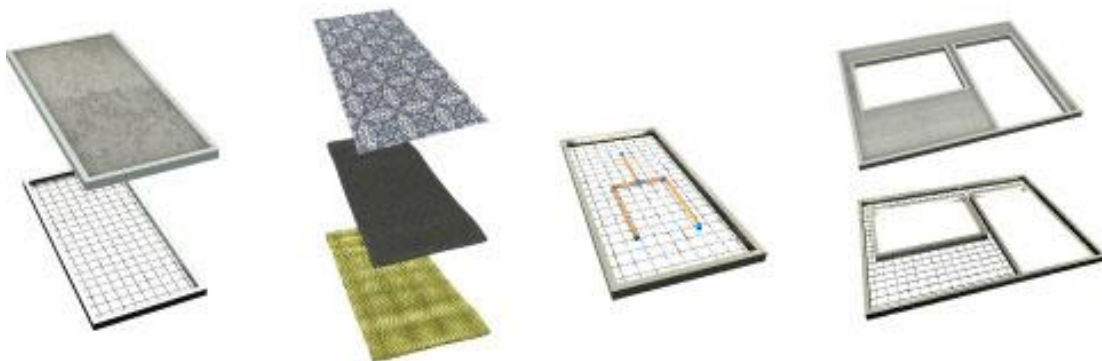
Ilustração dos painéis com acabamentos e instalações. Fonte: Falco Construções.
